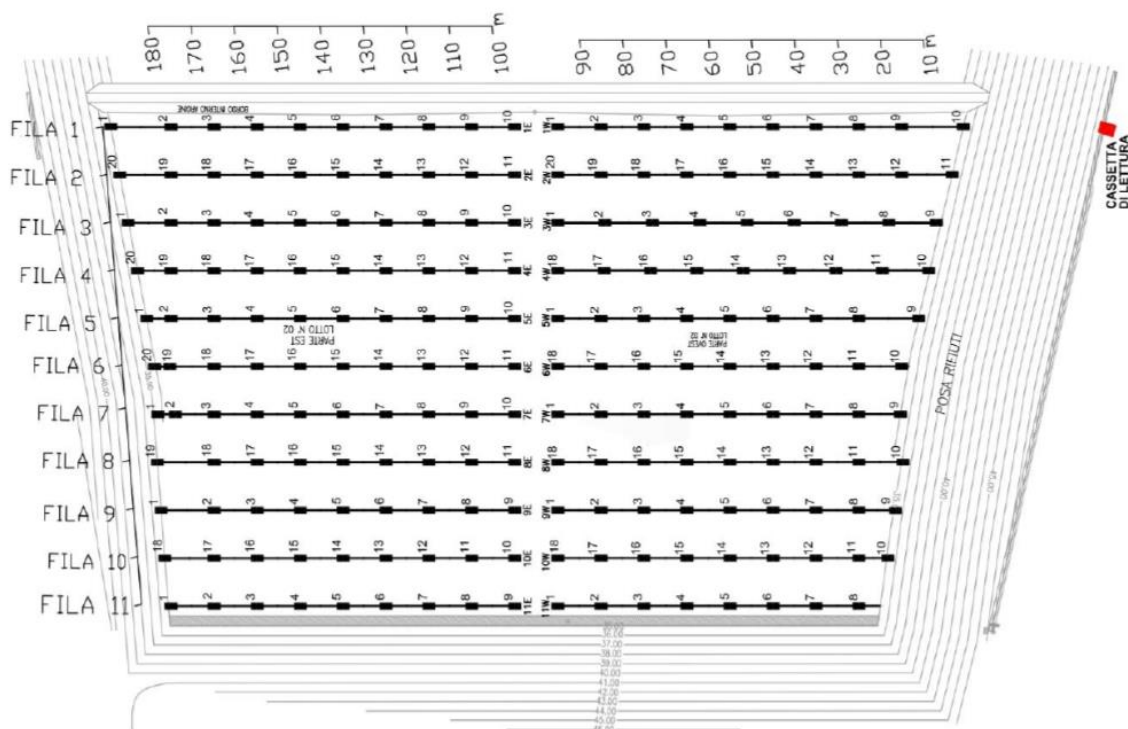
Schema del sistema di monitoraggio geoelettrico- Planimetria II Lotto S.I.Ge.D. con posizionamento elettrodi
